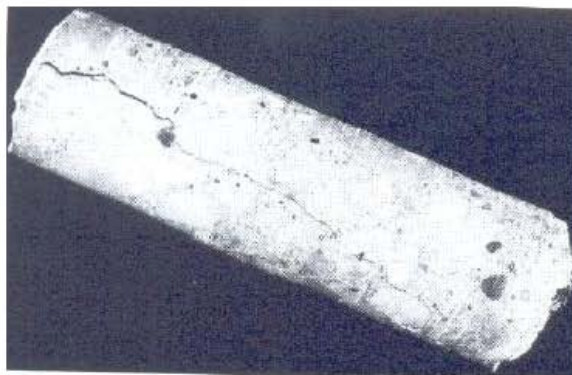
Las grietas de contracción por secado usualmente son más anchas en la superficie que hacia adentro (Trout, 2006)
